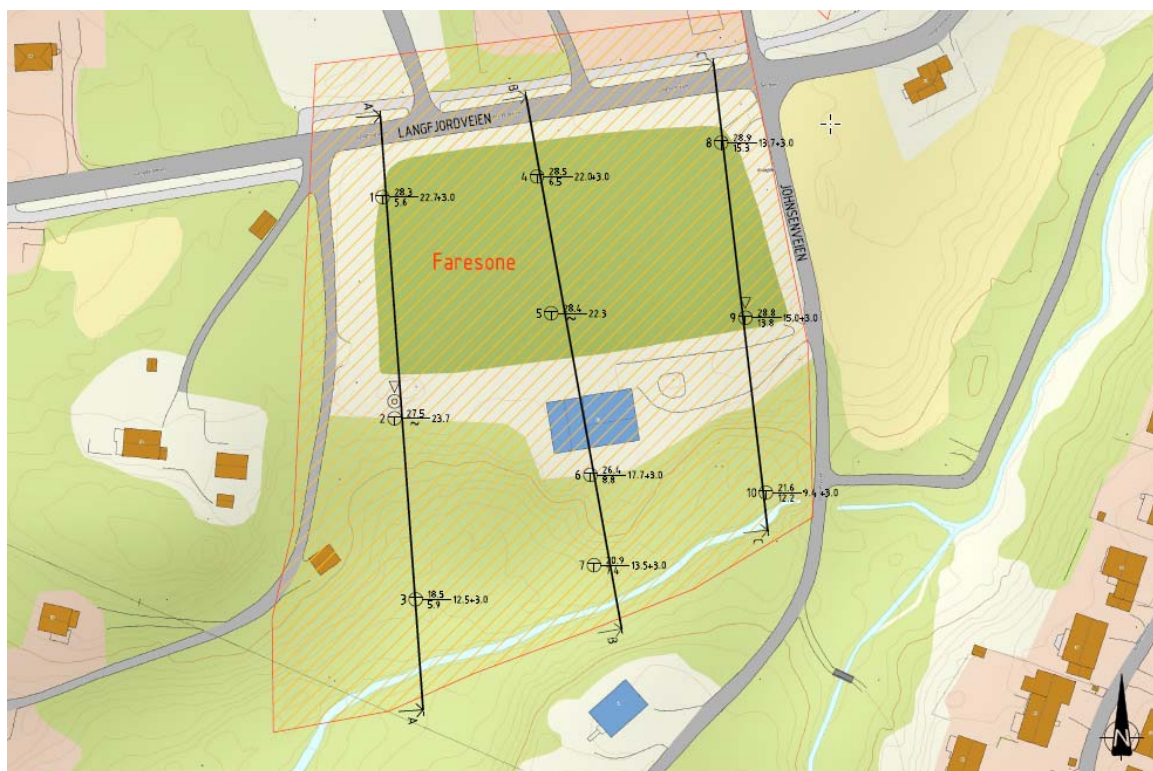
Situasjonsplan med planlagt bebyggelse på området.
